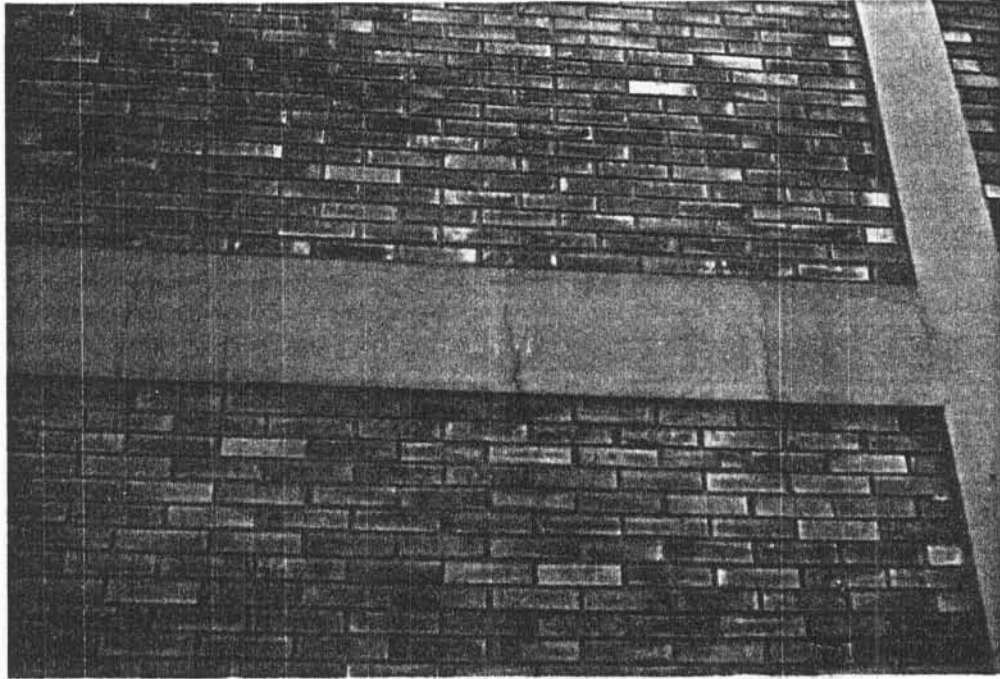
Fissuras em viga formadas pela ação conjunta da retração por secagem e contração térmica.
